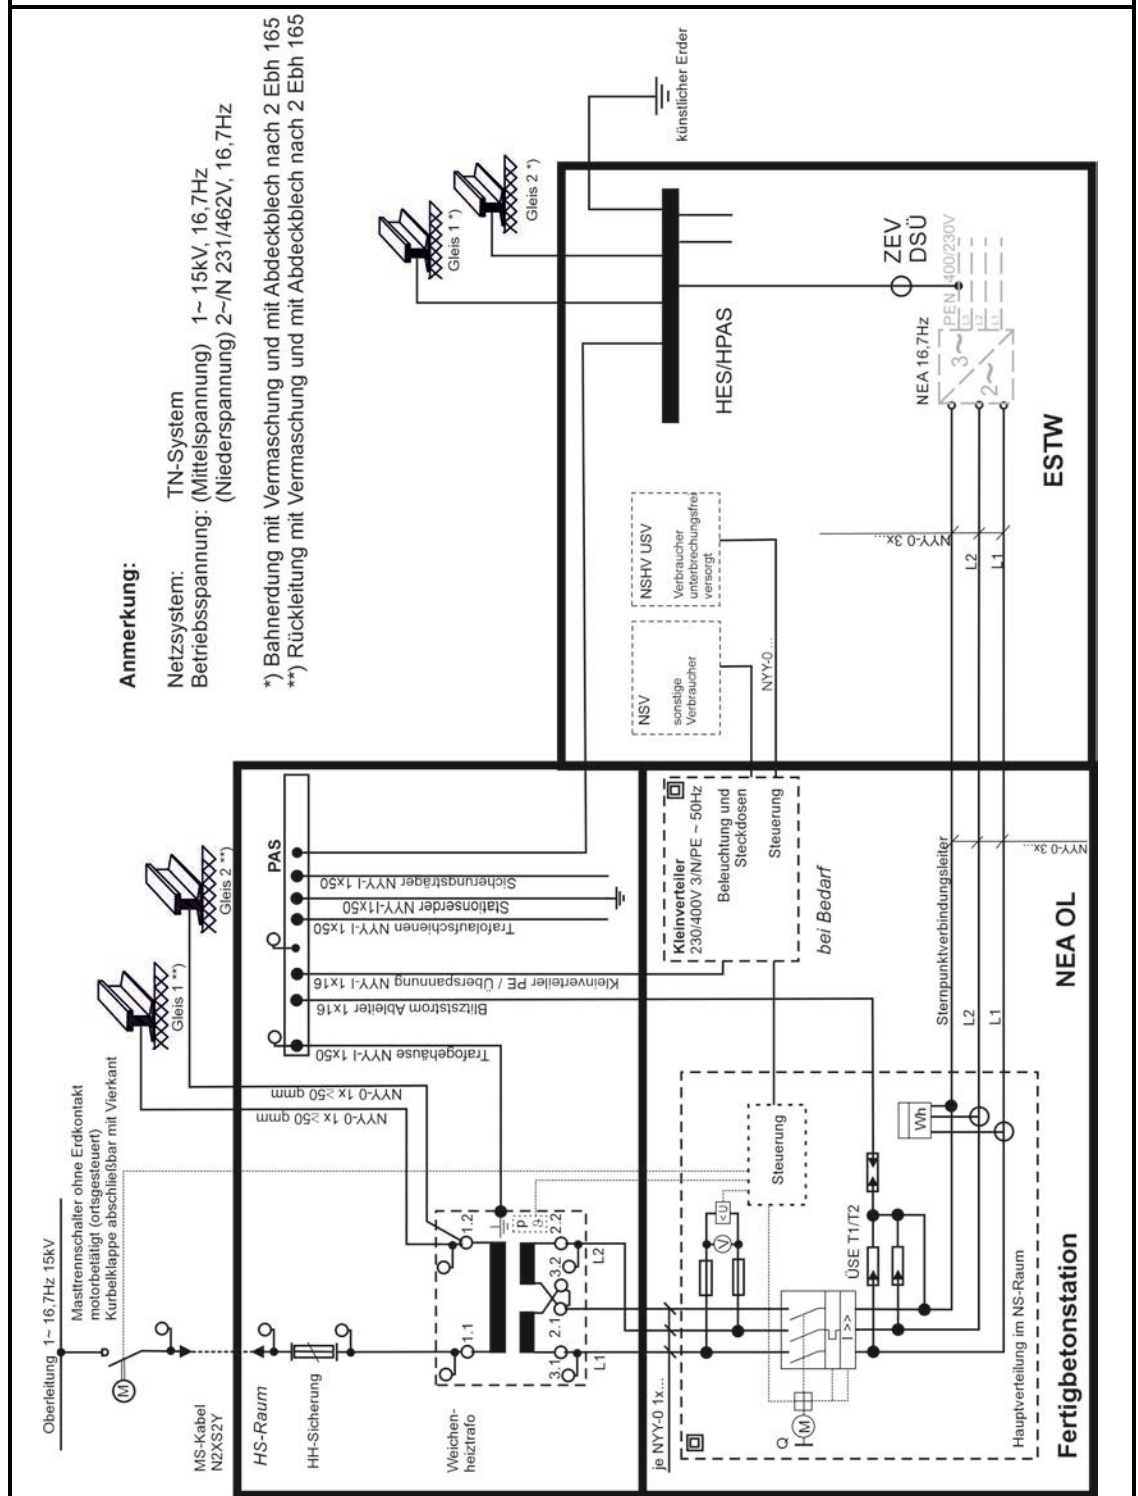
NEA OL Ausführung im Stellwerksgebäude Übersichtsschaltplan
